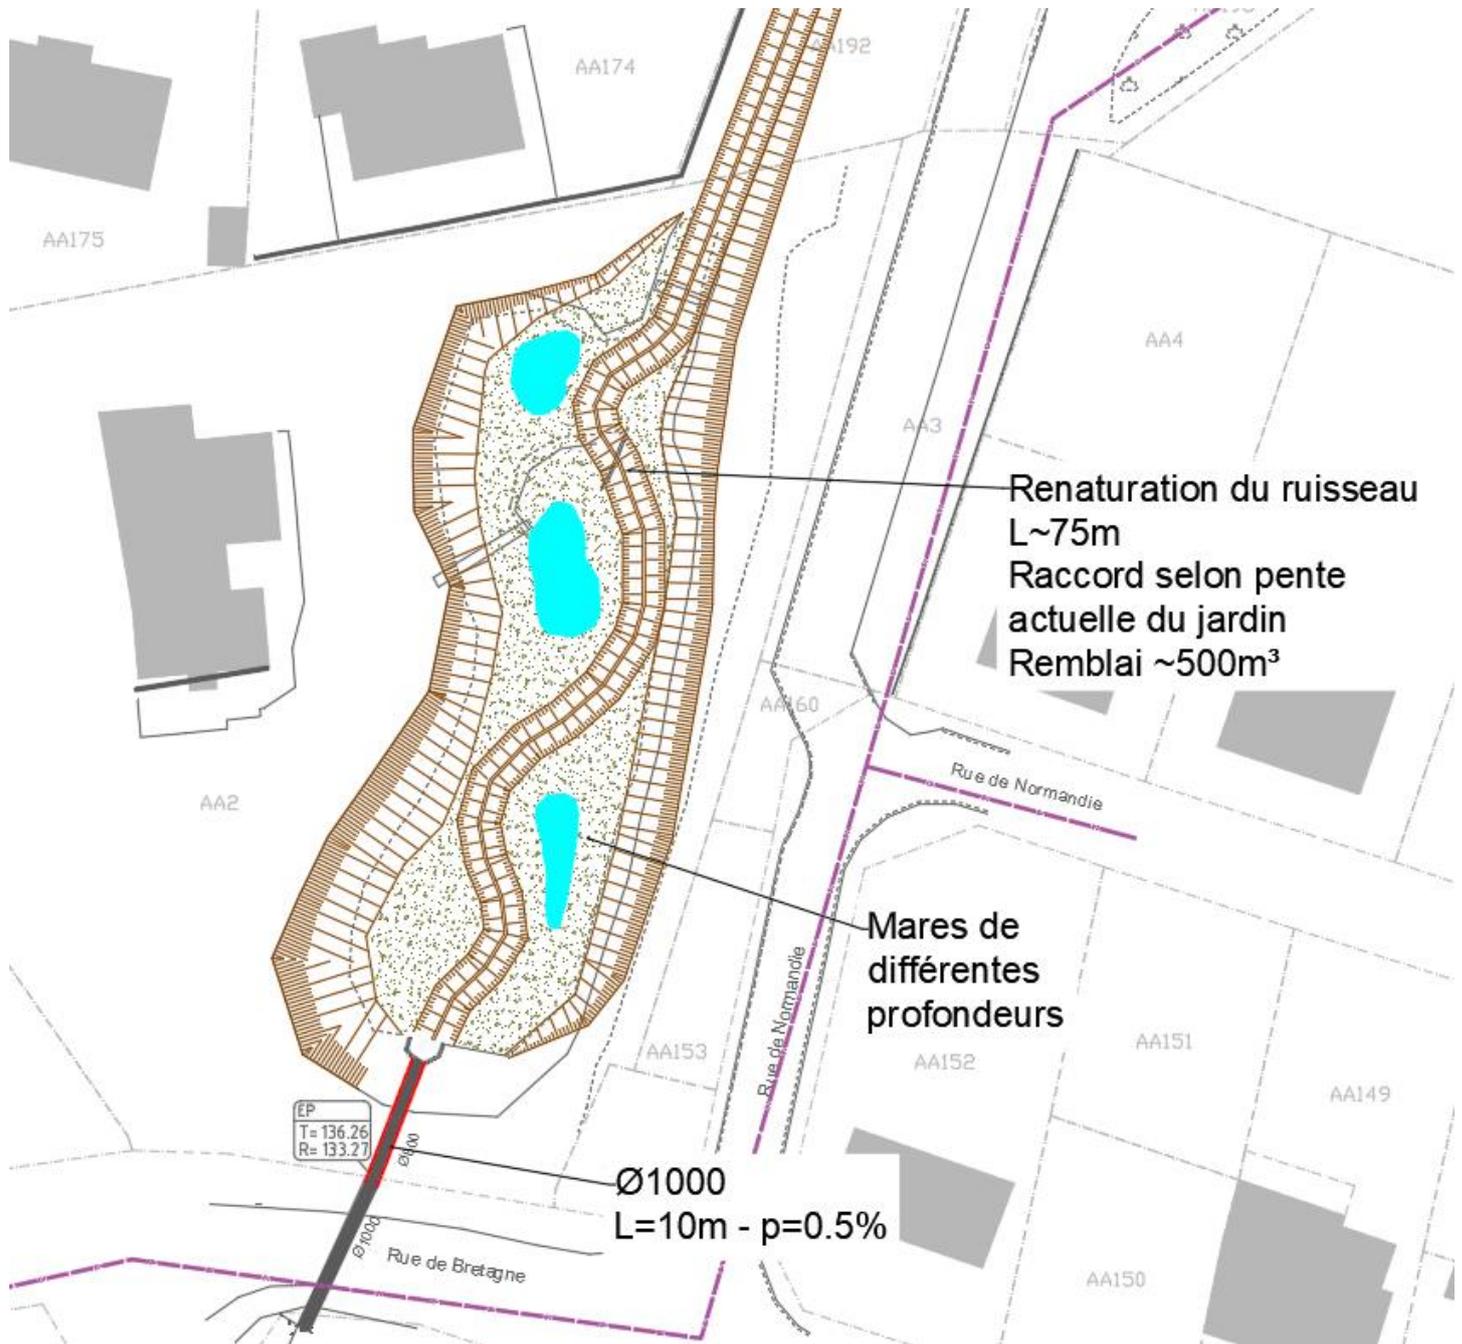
APS RCE 1, 2 et 3 – Vue en plan
